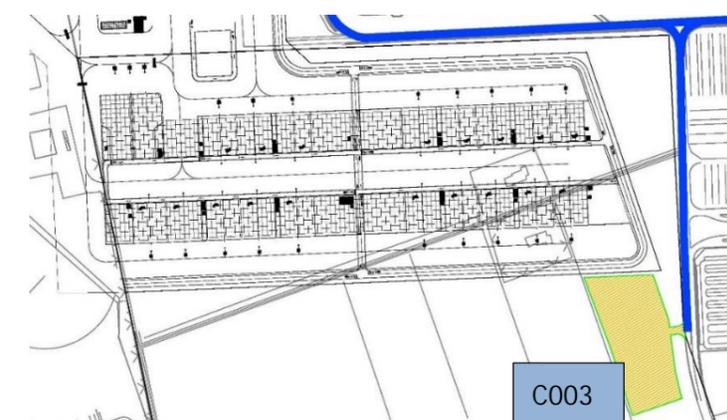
Planimetria con l'area di cantiere CO03 dell'Estensione dell'Apron
